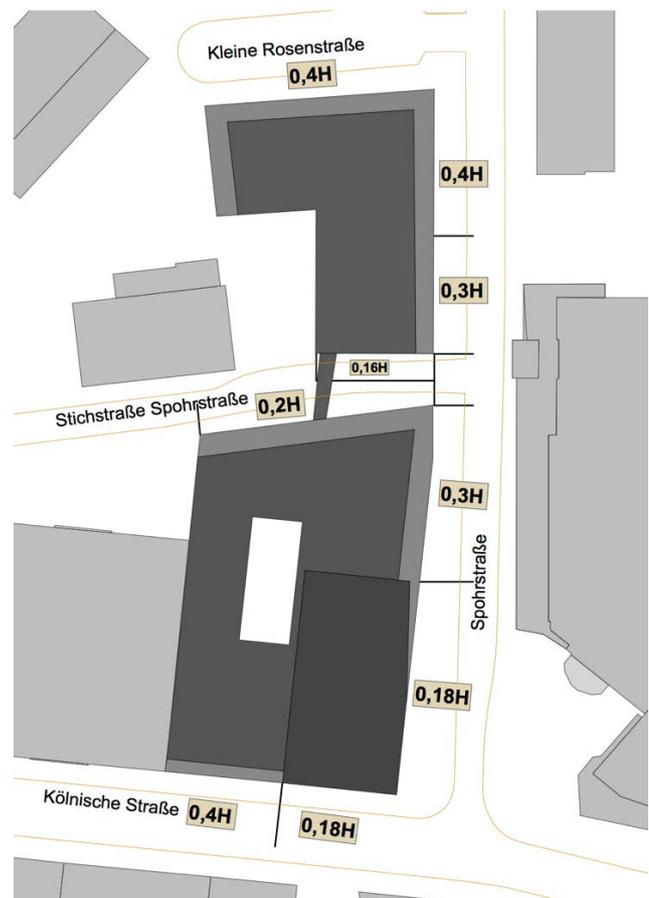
Übersichtsplan zu den im Bebauungsplan getroffenen Regelungen der vom Bauordnungsrecht abweichenden Maßen der Tiefe der Abstandsflächen (eigene Darstellung ohne Maßstab)
